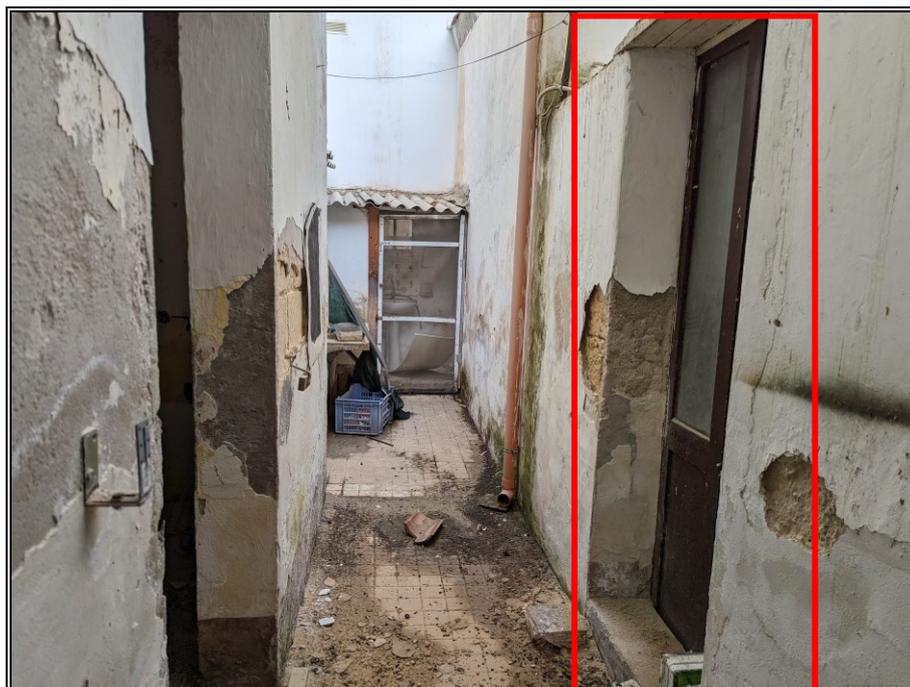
Cortile interno con particolare porta comunicante con proprietà contermine
